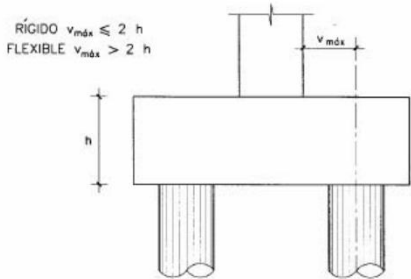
Condiciones para encepado rígido o flexible (Guía de cimentaciones).
